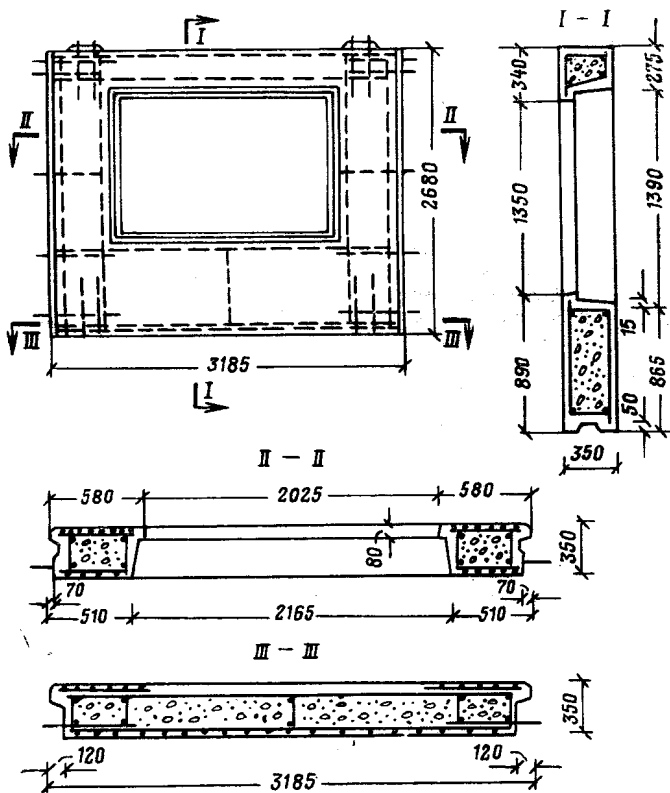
Конструкция перлитобетонной стеновой панели для строительства в сейсмических районах (8 баллов)
